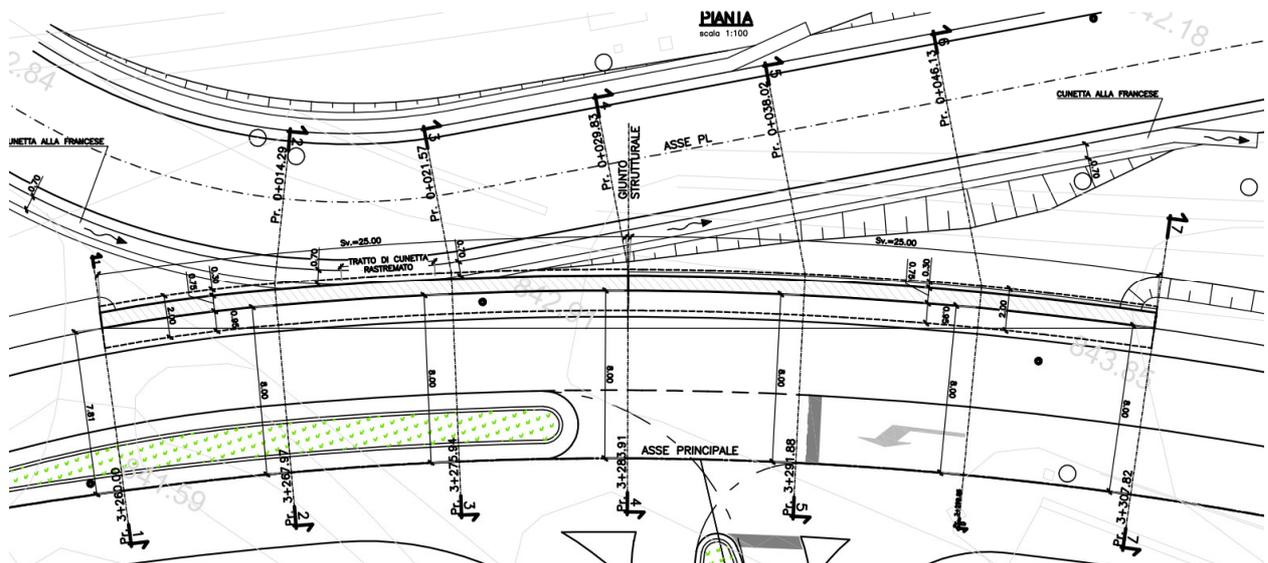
Planimetria e sezioni trasversali del muro su fondazione diretta
